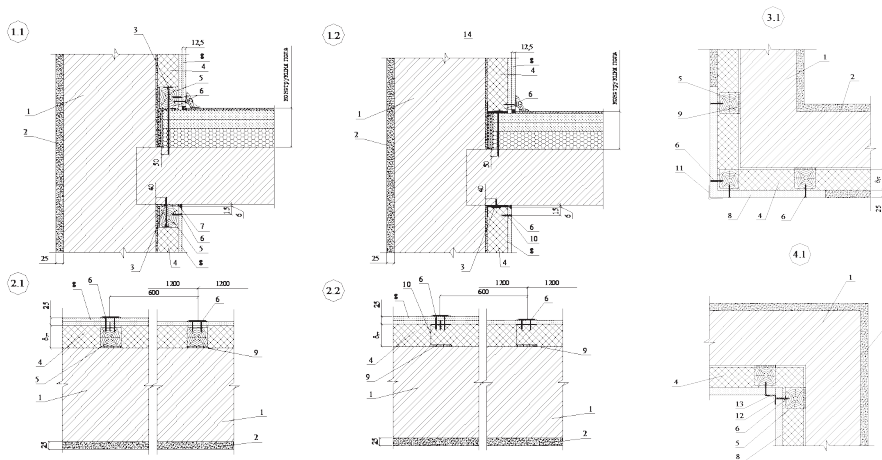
Вузли конструкції зовнішніх стін із теплоізоляцією розташованою з боку приміщень. Вузли 1.1 – 4.1
